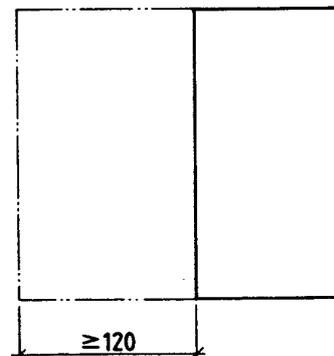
Bewegungsfläche vor einer Längsseite des Bettes des Nicht-Rollstuhlbenutzers
